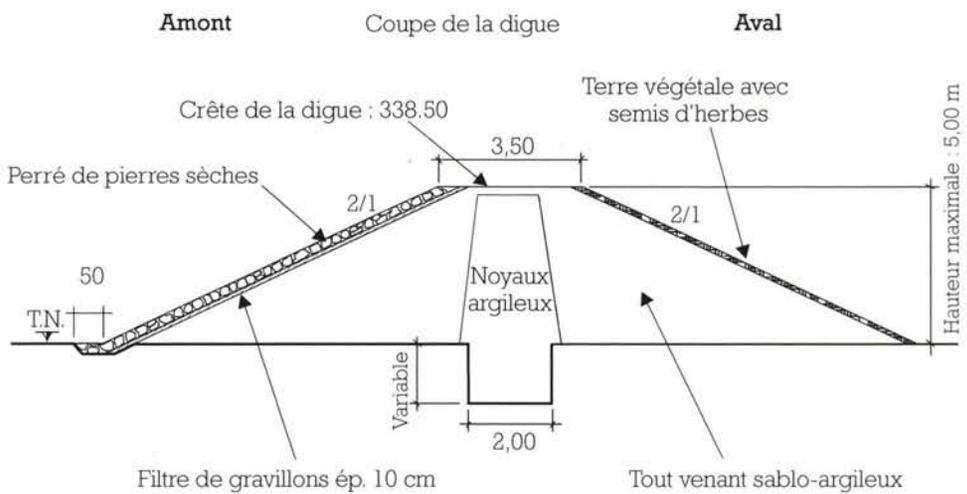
C-1 : Coupe en travers du barrage de Tia (extrait de[2]).
